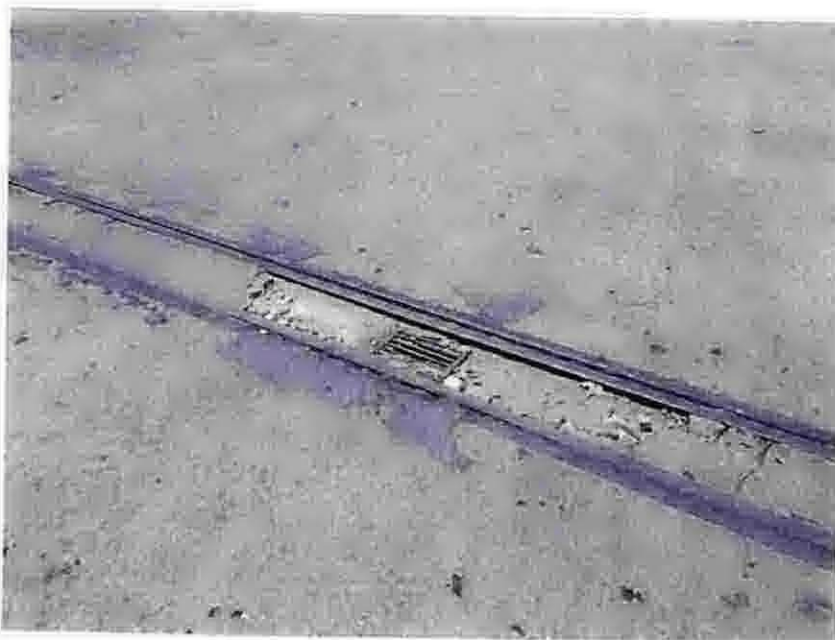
Pátio elevado: apresenta problemas nas juntas do pavimento.
